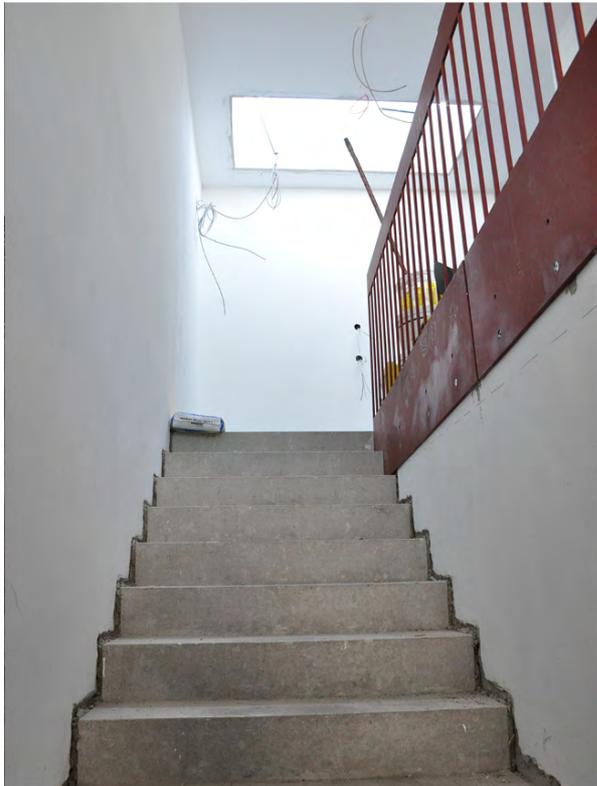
Haupttreppe - 2. Obergeschoss, 15.05.2019
